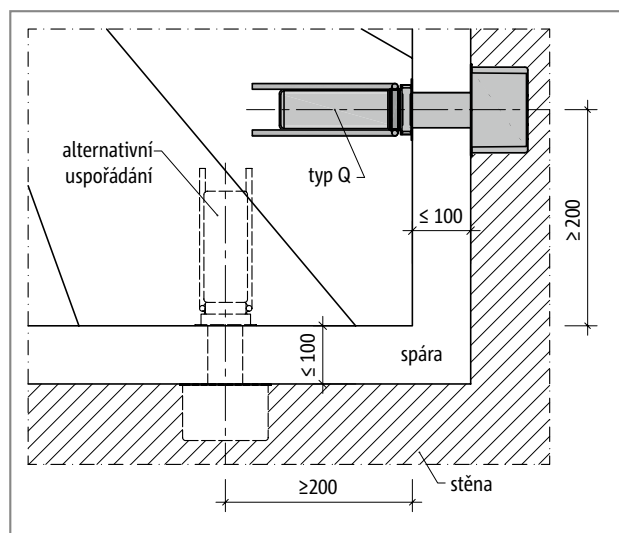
Schöck Tronsole® typ Q: Uspořádání prvků, detail A, tloušťka spáry $b = 15$ mm u monolitických konstrukcí; u prefabrikovaných schodiškových ramen musí projektant ověřit, zda není nutno uvažovat s přidavnou montážní tolerancí
